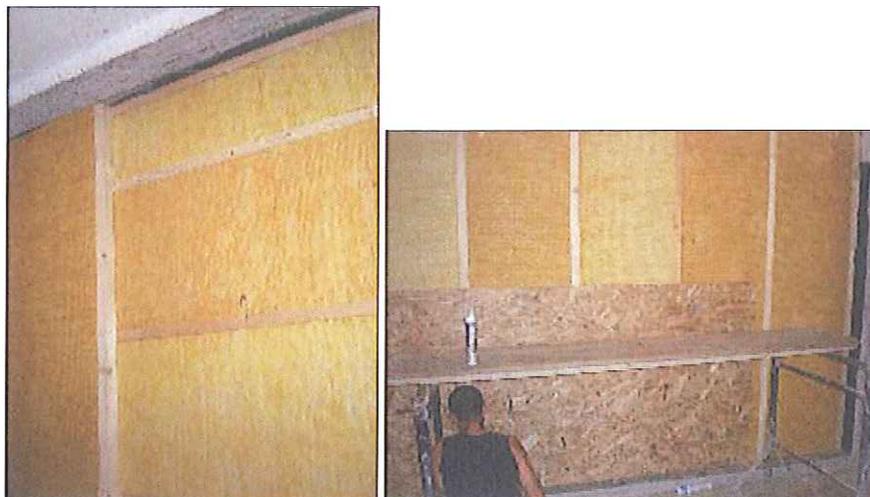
Campione in prova: ISOVER BAC CF N Roofline® posato in doppio strato 60 mm + 60 mm incrociato tra i listelli e posa secondo OSB.
